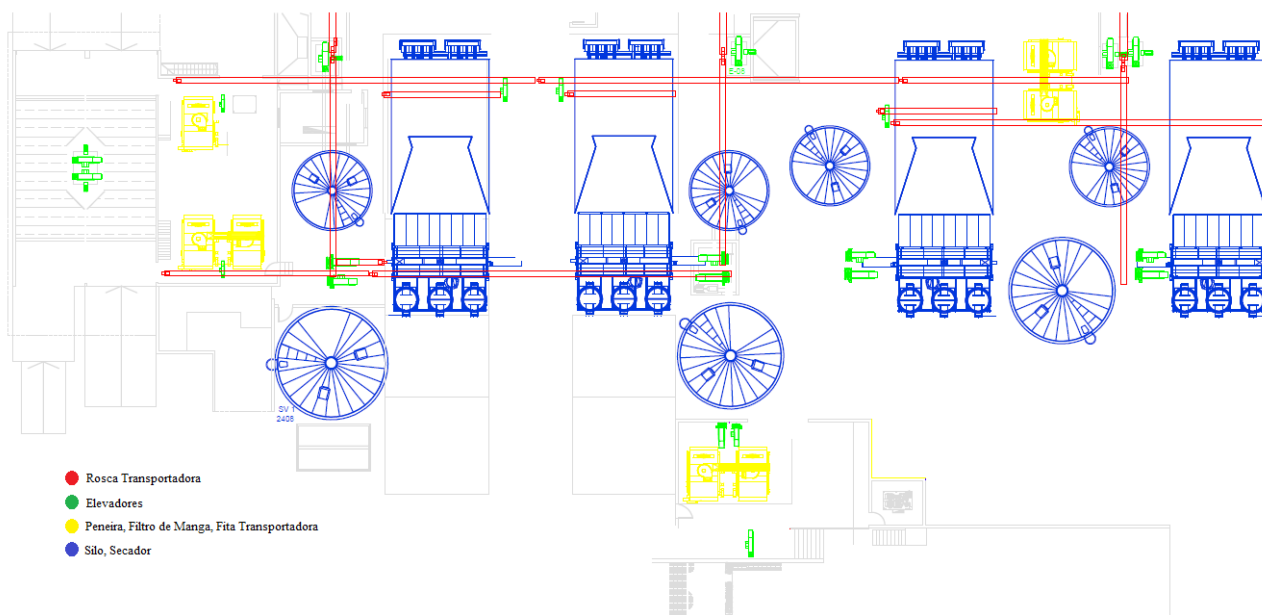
Planta da área de secagem do engenho, com identificação dos tipos de máquinas
